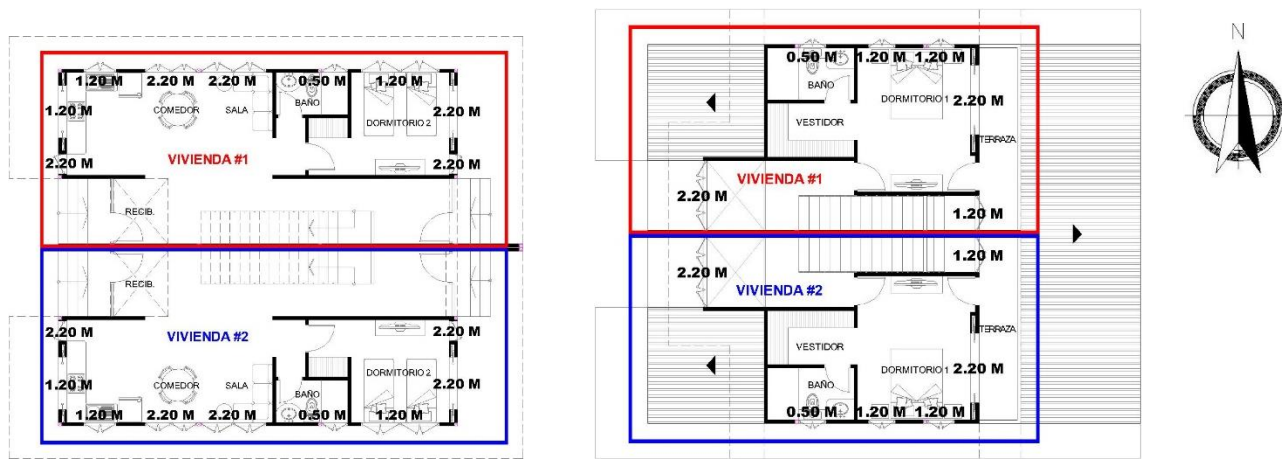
Vivienda #1 y #2 con alturas de ventanas situadas en Planta baja y planta Alta. Elaboración Propia
